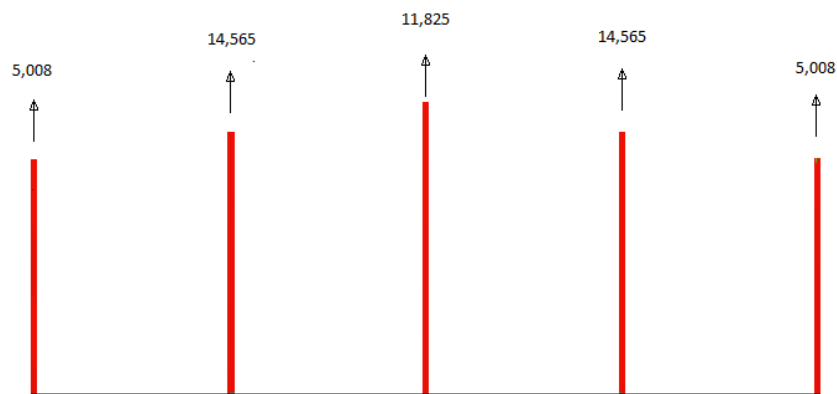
Acción del viento VF1+VIS en cubiertas sobre pilares de fachada.
